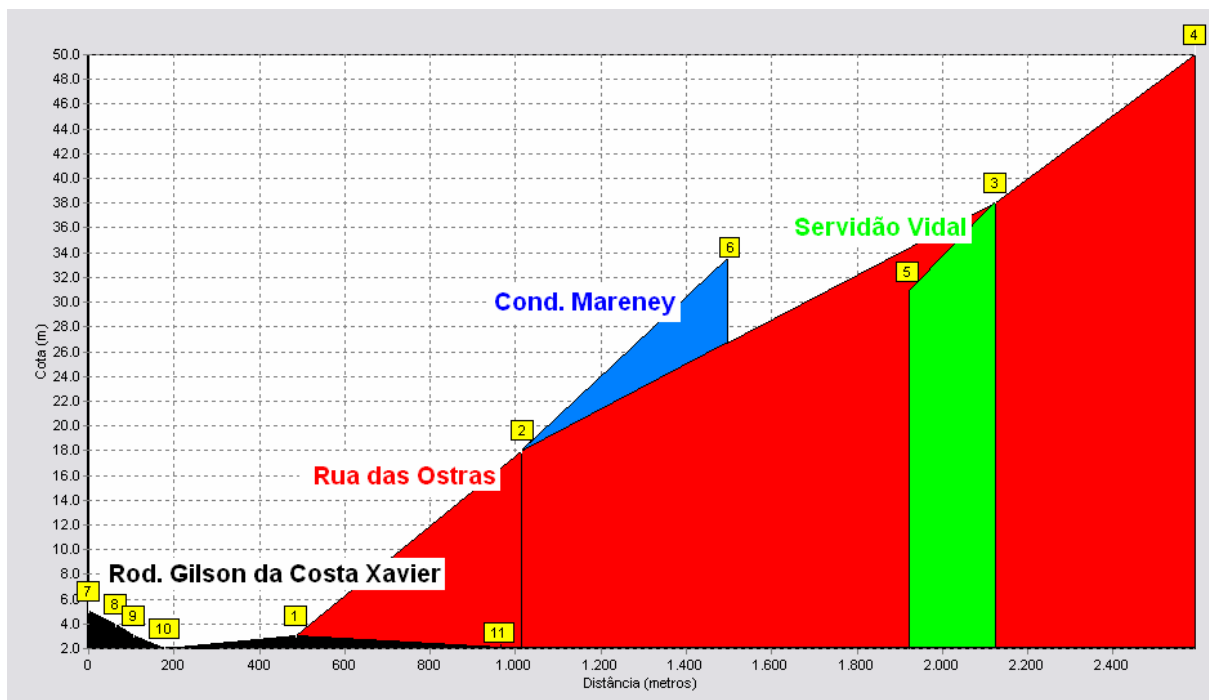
Perfil longitudinal do SAA – área piloto (Ponta do Sambaqui).
